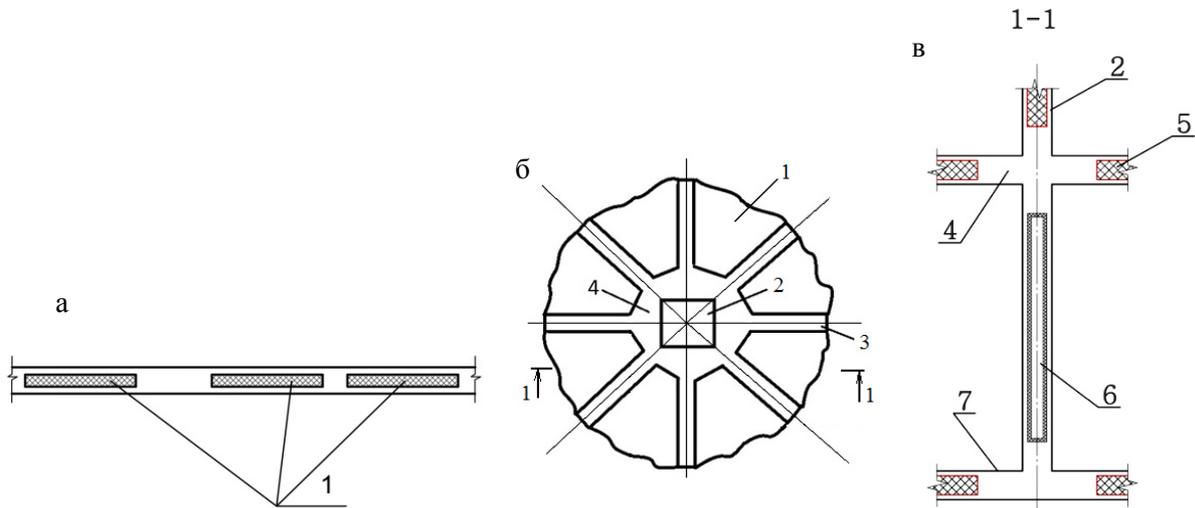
Особенности конструкции каркаса «МОНОФАНТ»: а – разрез плиты перекрытия; б – устройство капители каркасного здания; в – размещение вкладышей в элементах каркасного здания; 1 – вкладыш; 2 – колонна; 3 – внутренние ребра жесткости плиты; 4 – капитель; 5 – вкладыш сплошного сечения; 6 – вкладыш с пустотами внутри; 7 – фундамент
